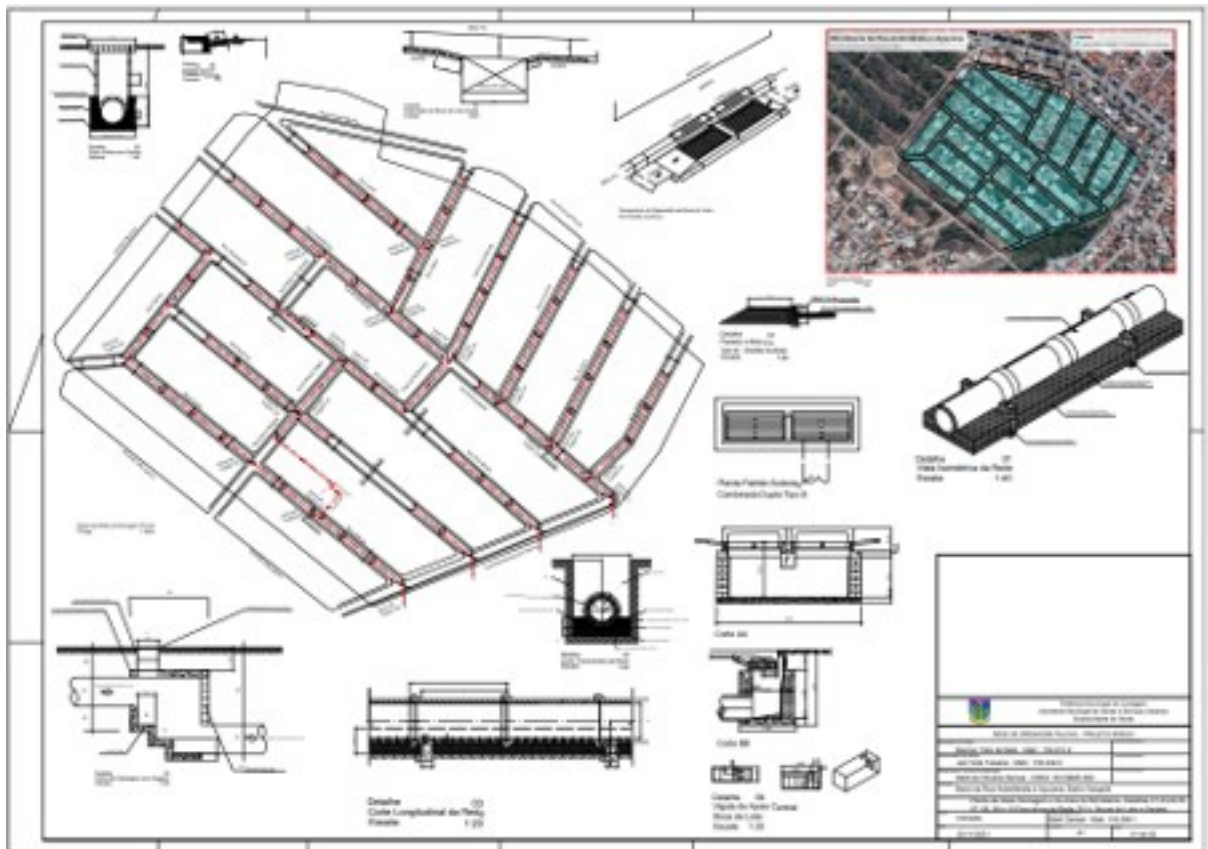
Projeto da rede de drenagem e detalhes construtivos
